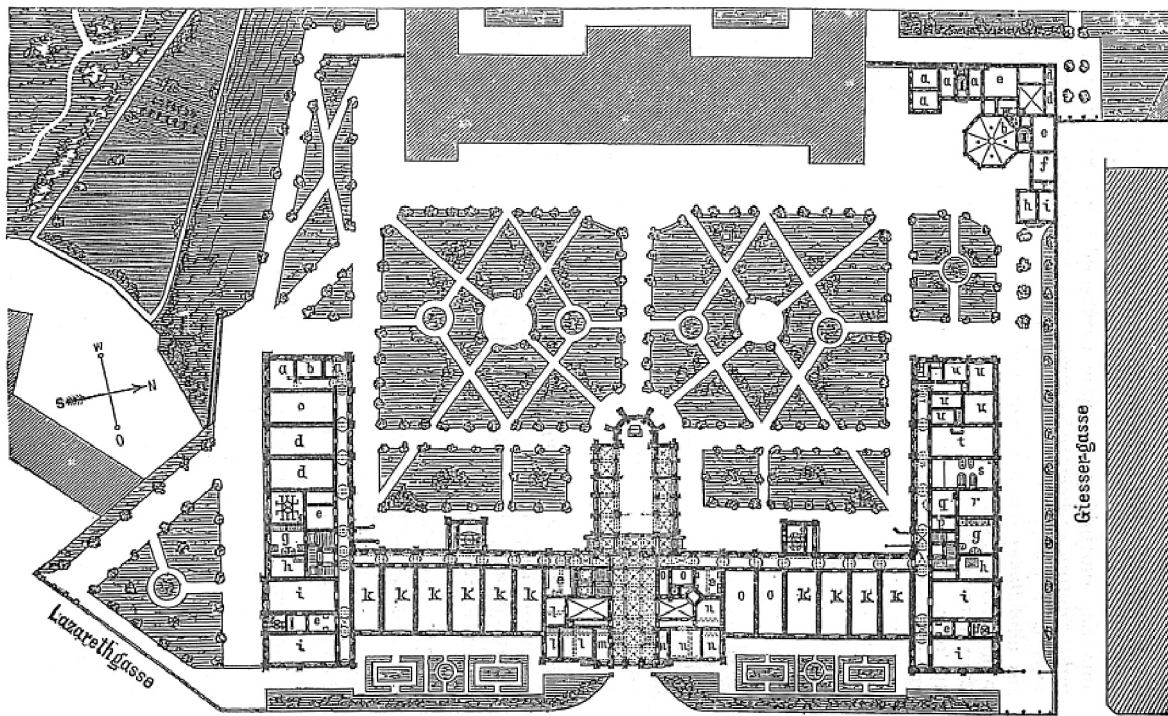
Armenhaus am Alserbach, Spitalgasse 23, Grundriss.
